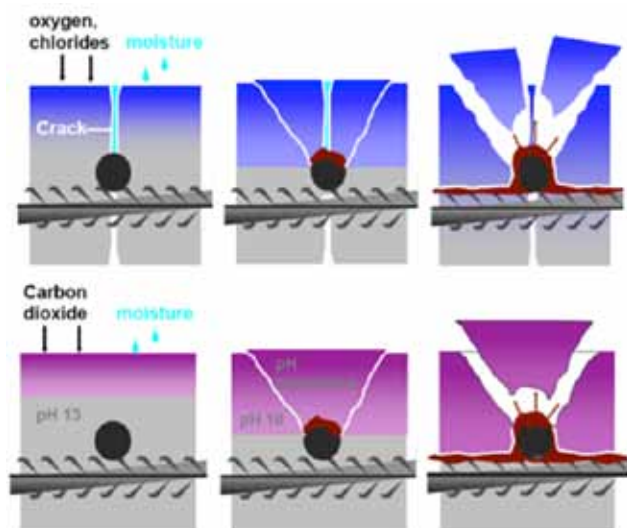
Ilustración del proceso de afectación de las estructuras de hormigón armado.
